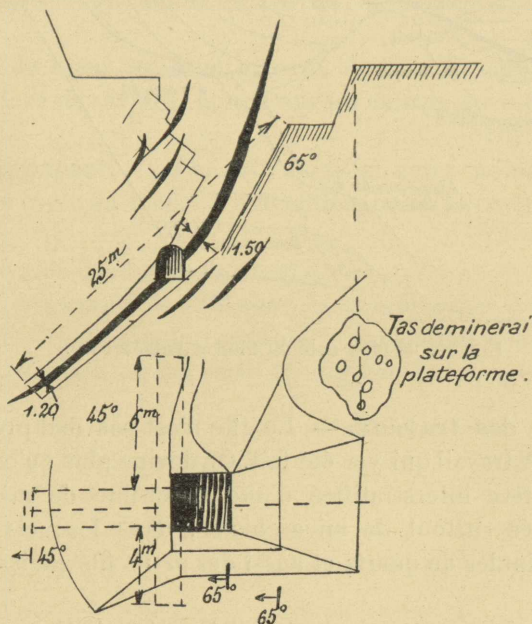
Plan et coupe de la descenderie dans le filon.
